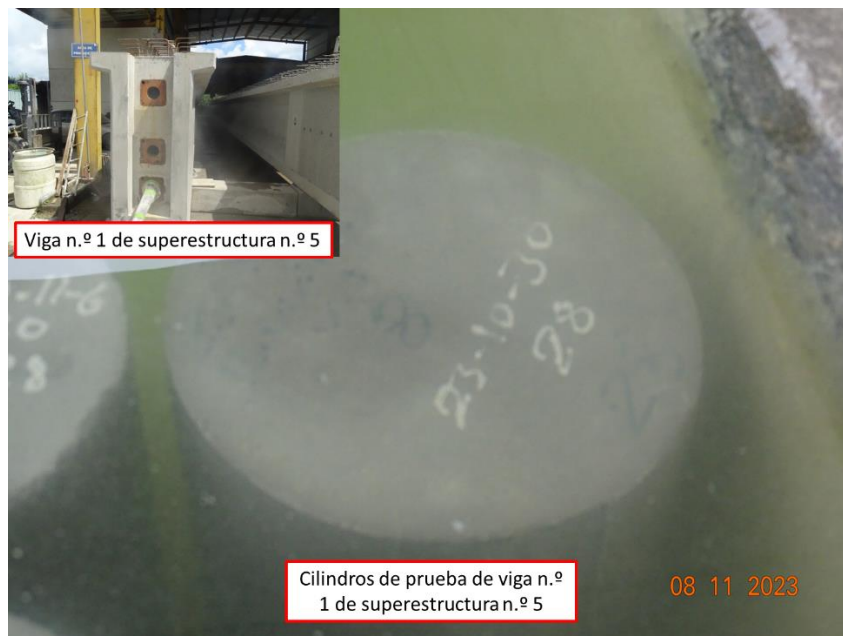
Cilindros de prueba para viga n.º 1 de superestructura n.º 5
